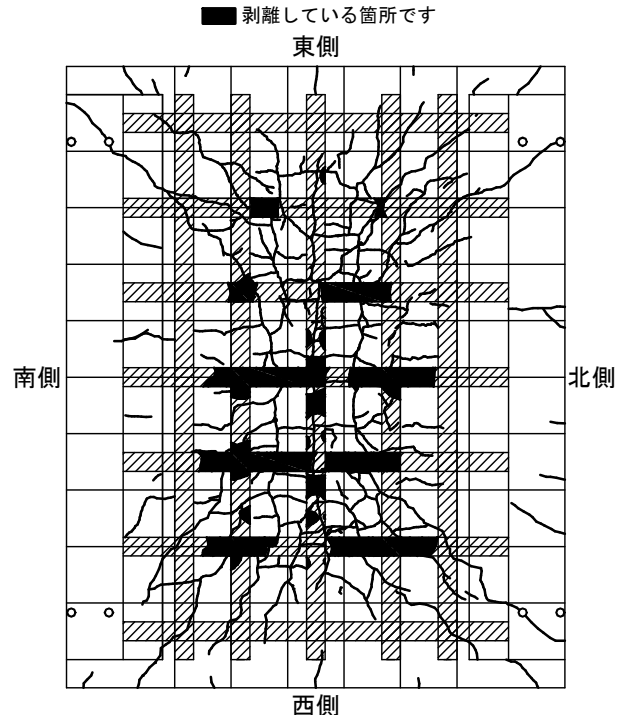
CFRP プレート剥離・ひび割れ状況 (実験 2 補強荷重終了時)
